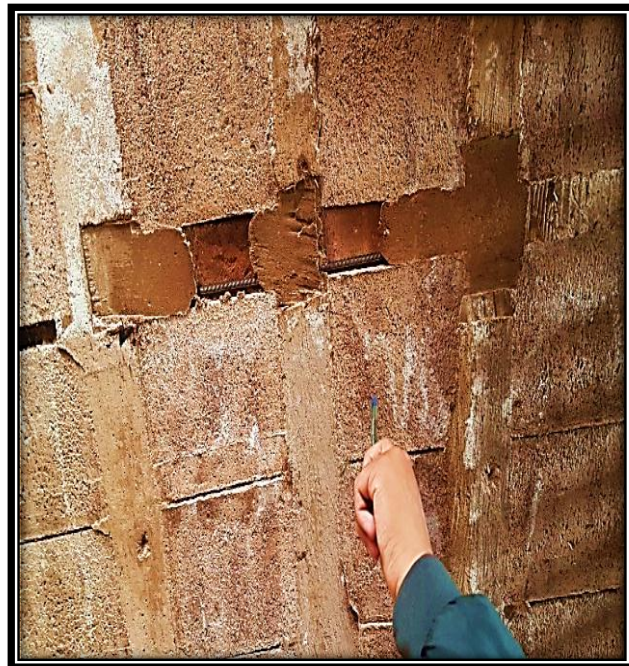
Grieta en muro por asentamiento diferencial
